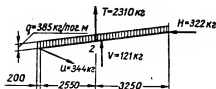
Определение усилий в верхнем поясе фермы при подъеме.
